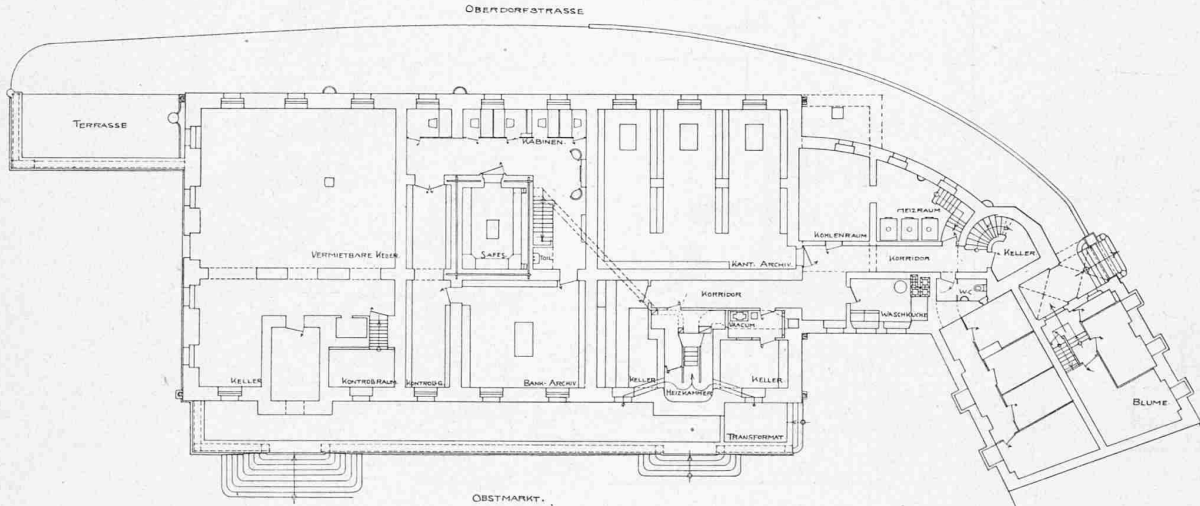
Grundriss vom Untergeschoss. — Masstab 1:400.
